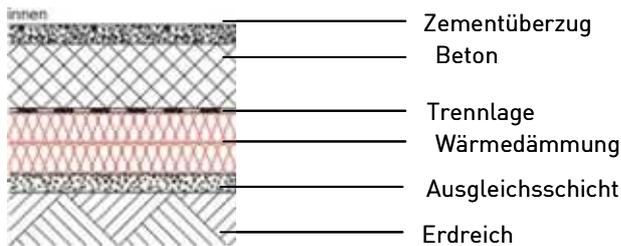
Aufbau der gedämmten Betonbodenplatte mit Zementunterlagsboden.
